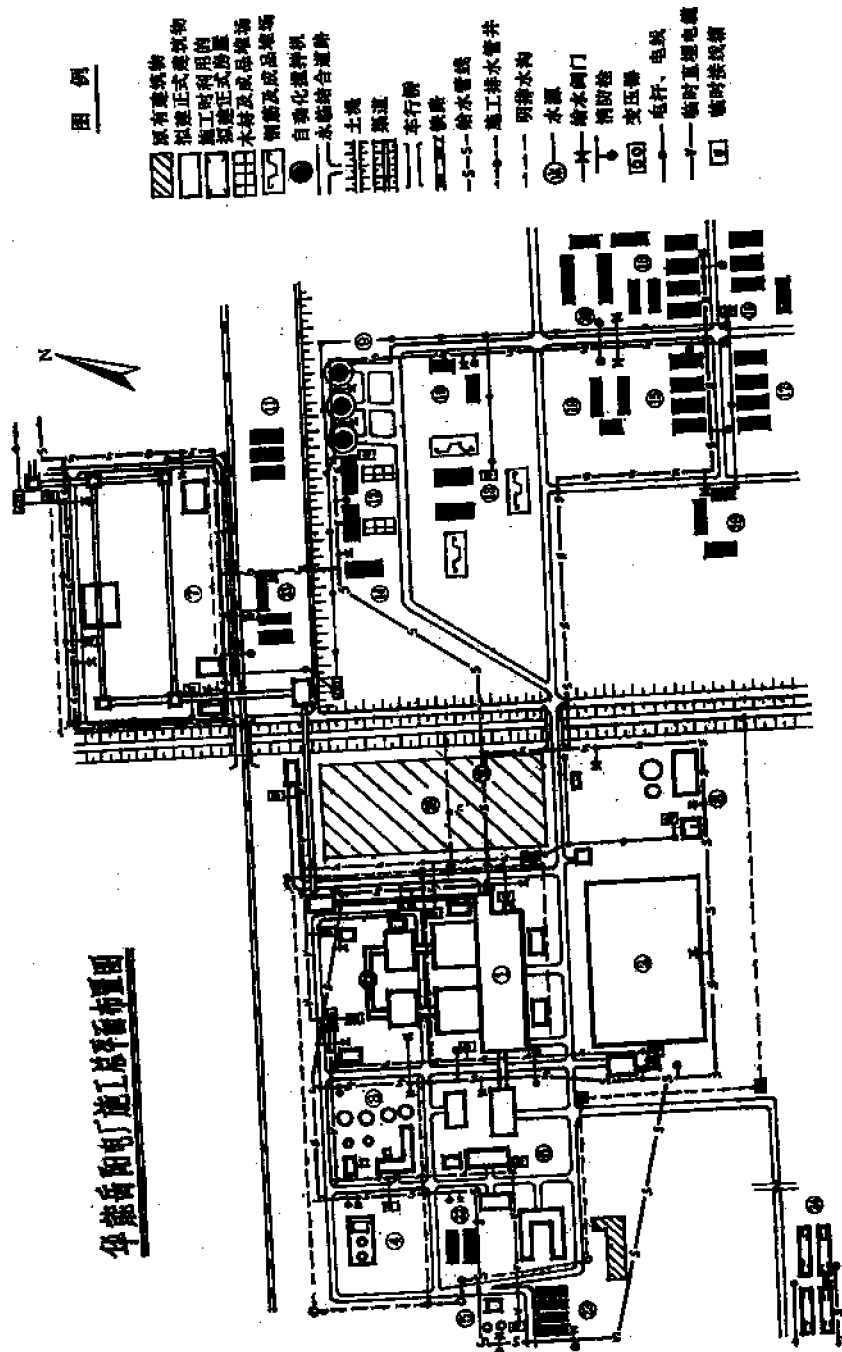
(10) 华能岳阳电厂施工总平面布置图
